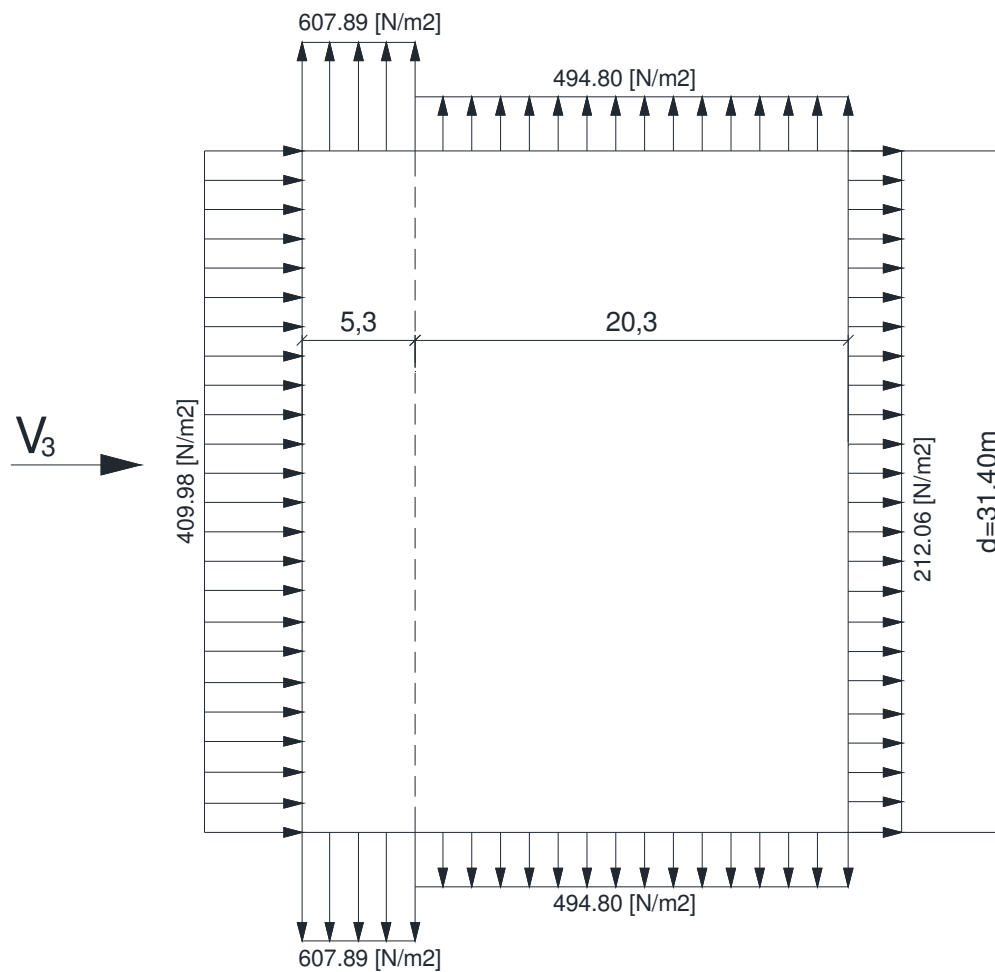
Pression du Vent – Parois verticales –Long-pan façade Est
